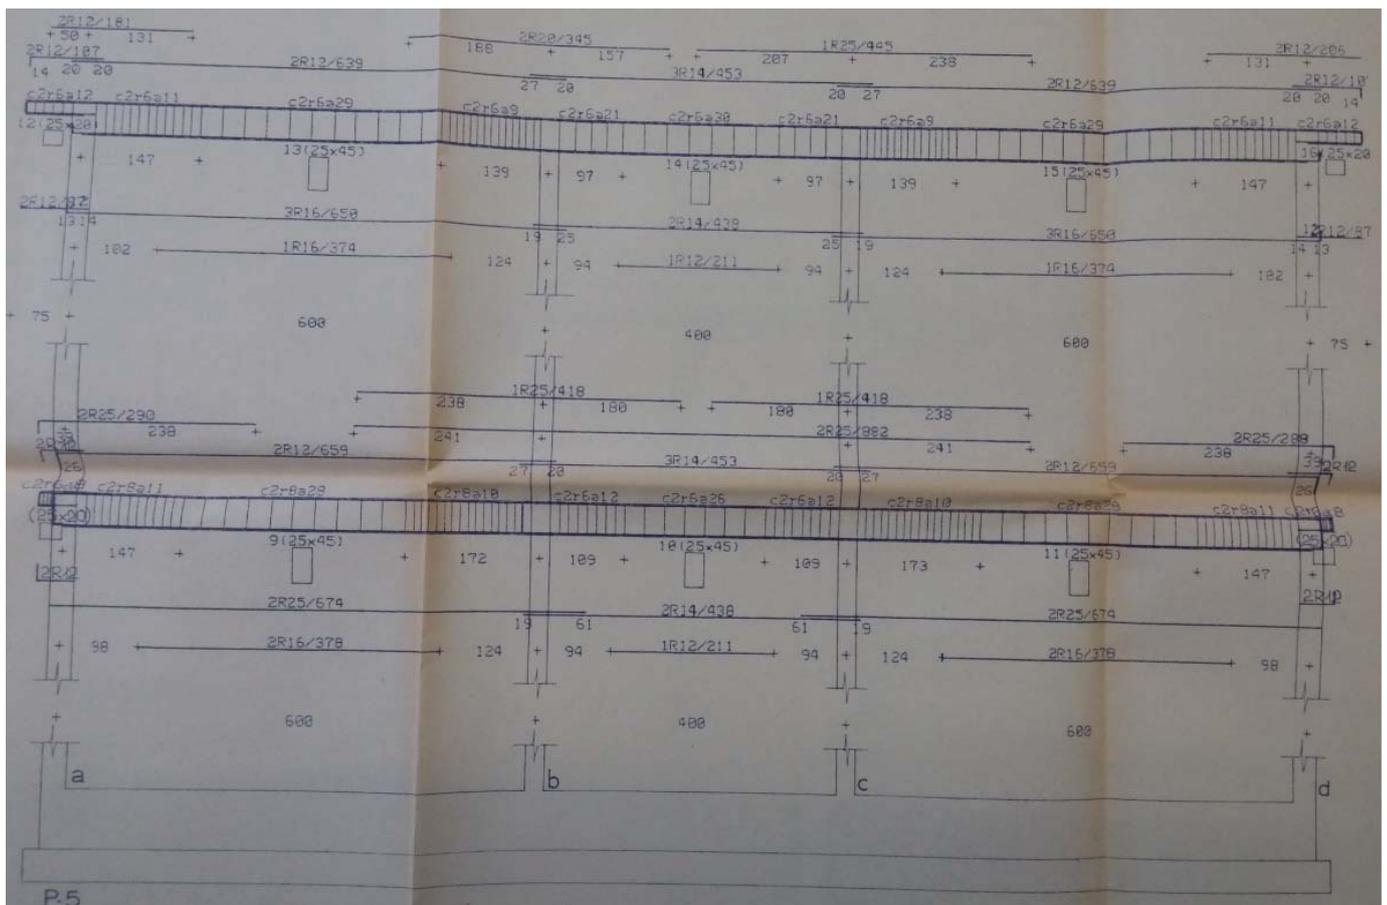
Pórtico P5. Geometría y armado de proyecto.
